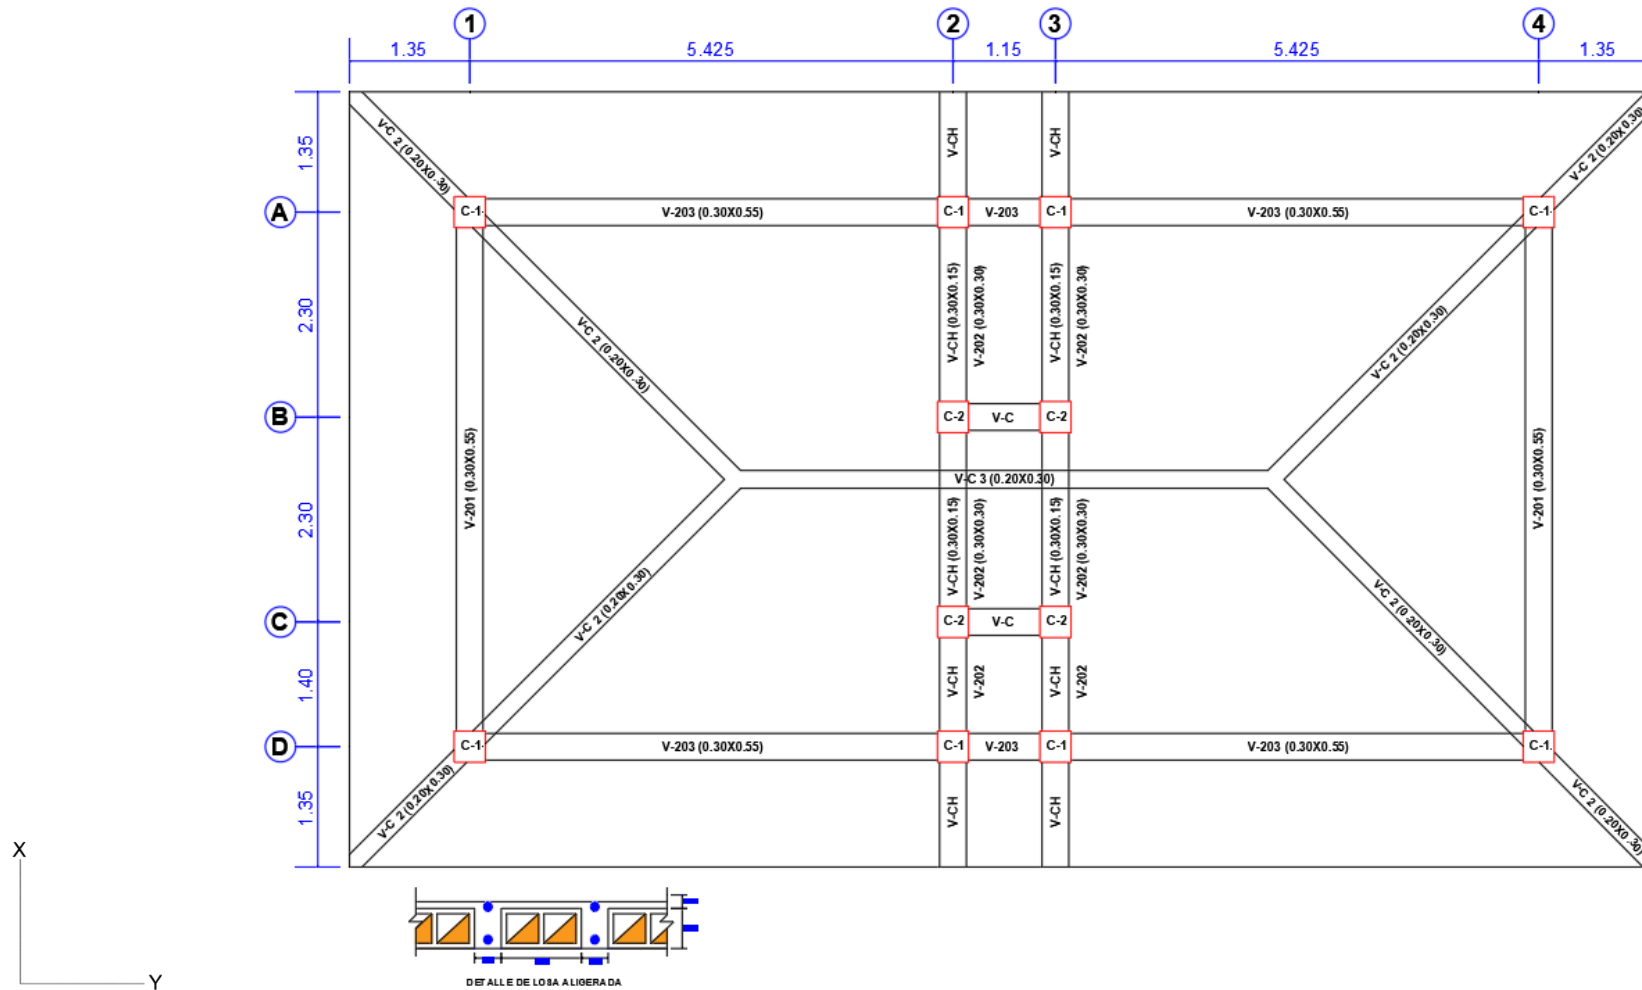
Distribucion de los elemetos estructurales del Segundo Nivel (Fuente: Archivos del Área de Archivo Central, de las obras ejecutadas en la Universidad Nacional de San Martín – Tarapoto)
